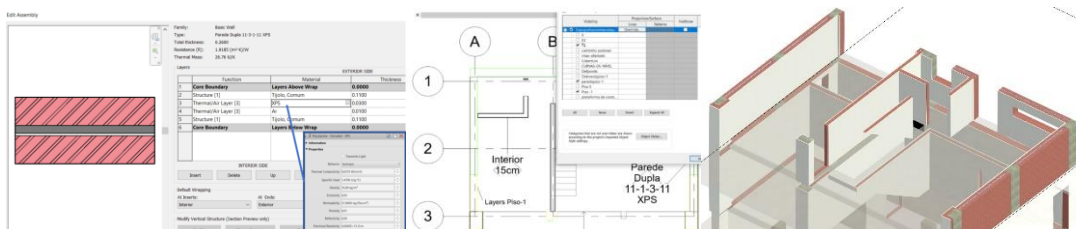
Objecto paramétrico de parede dupla e representação de paredes em planta
